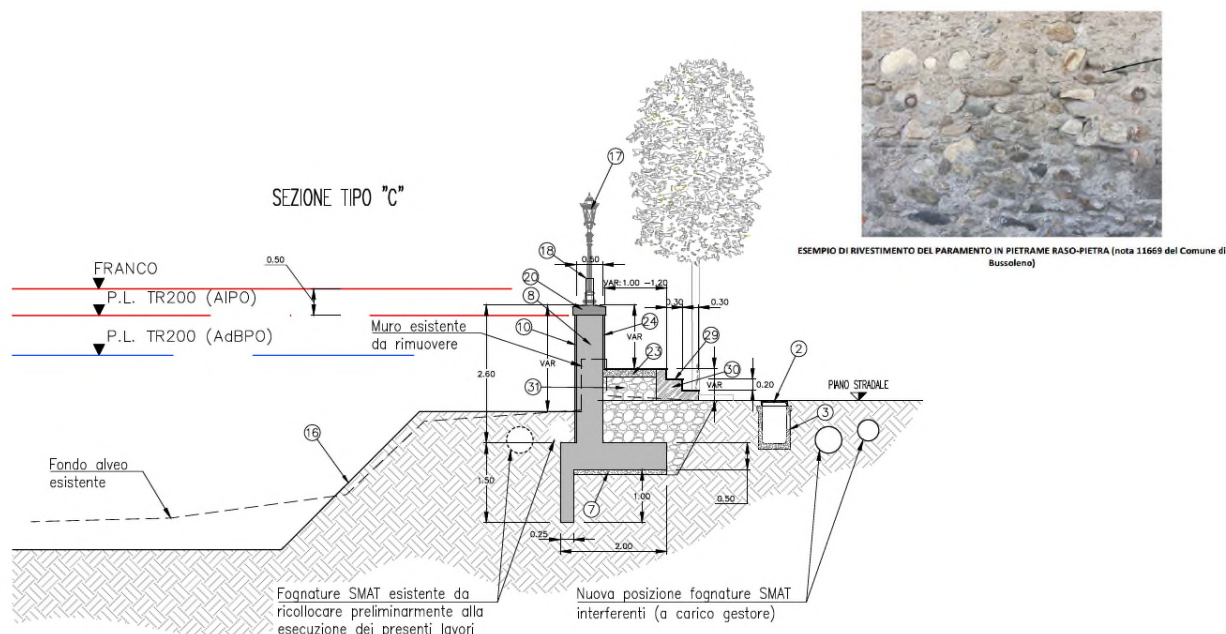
Sezione tipo di progetto in corrispondenza della sponda destra a valle del ponte Vecchio, secondo tratto.
